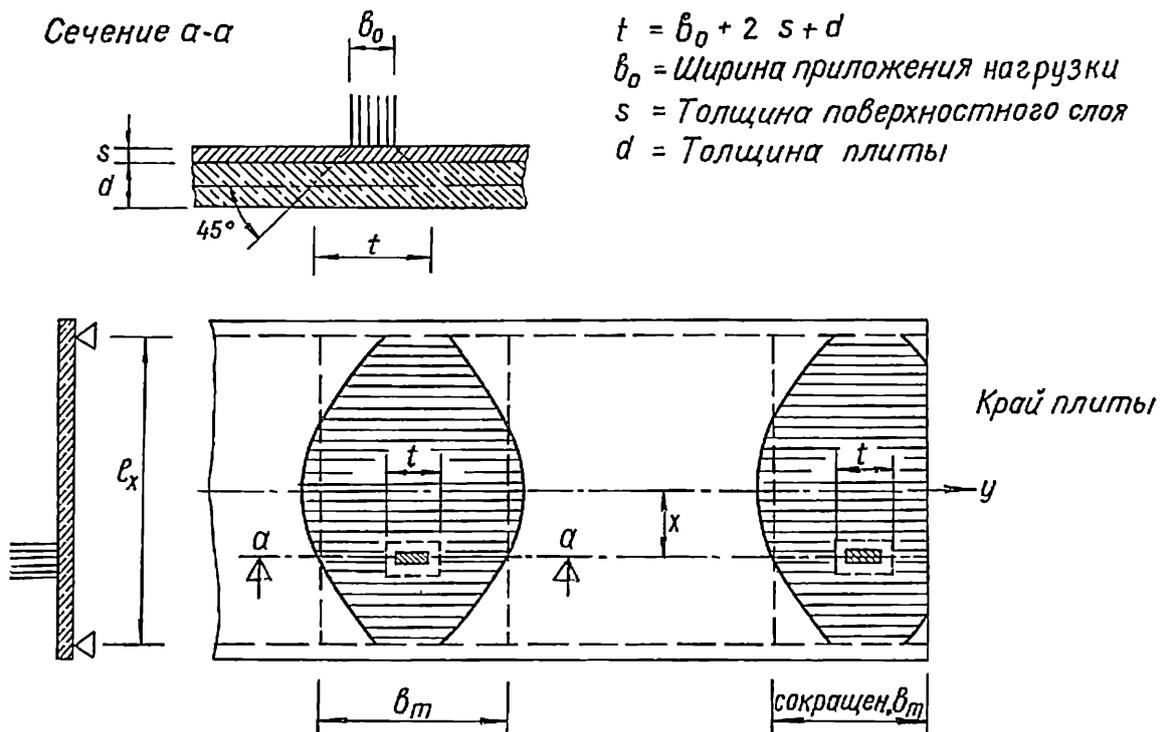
15. Расчетная эквивалентная ширина при сосредоточенных и распределенных по отрезку нагрузках для двусторонне опертых плит [2.5]
